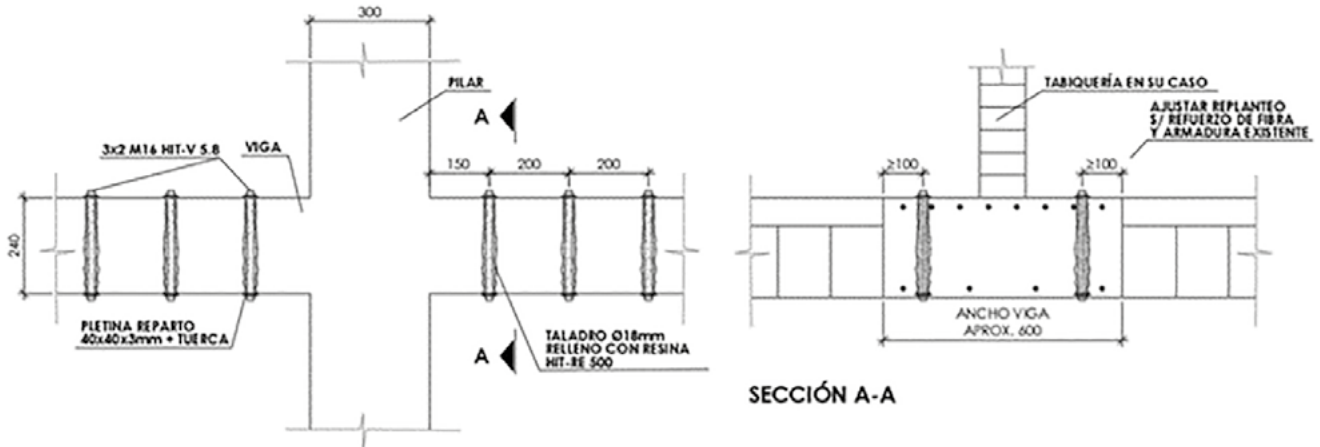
Refuerzo de vigas a cortante con barras pasantes.
